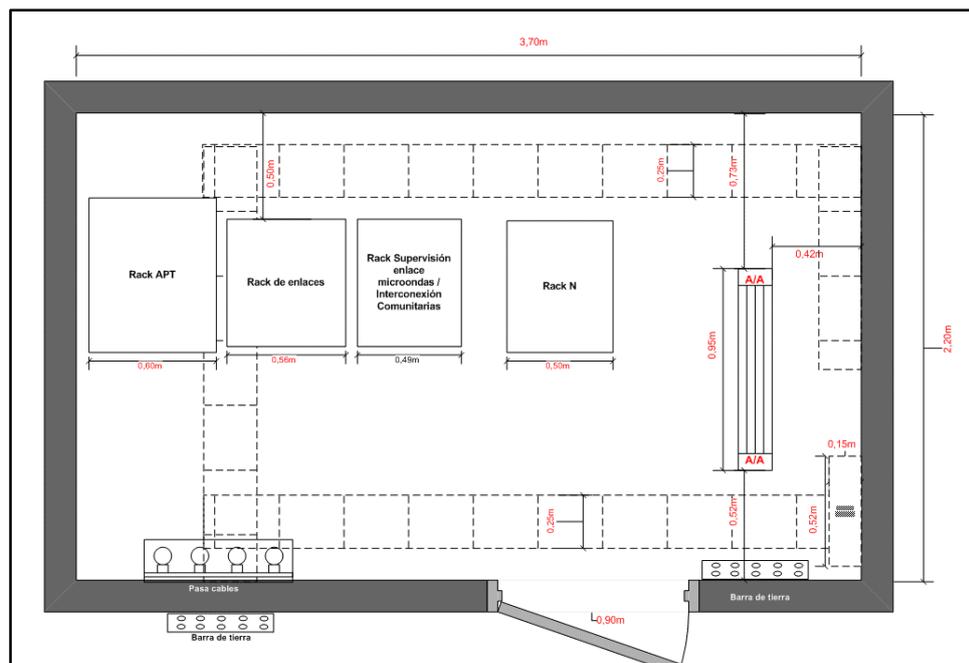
Levantamiento Planimétrico Master Azotea en Chapellin
